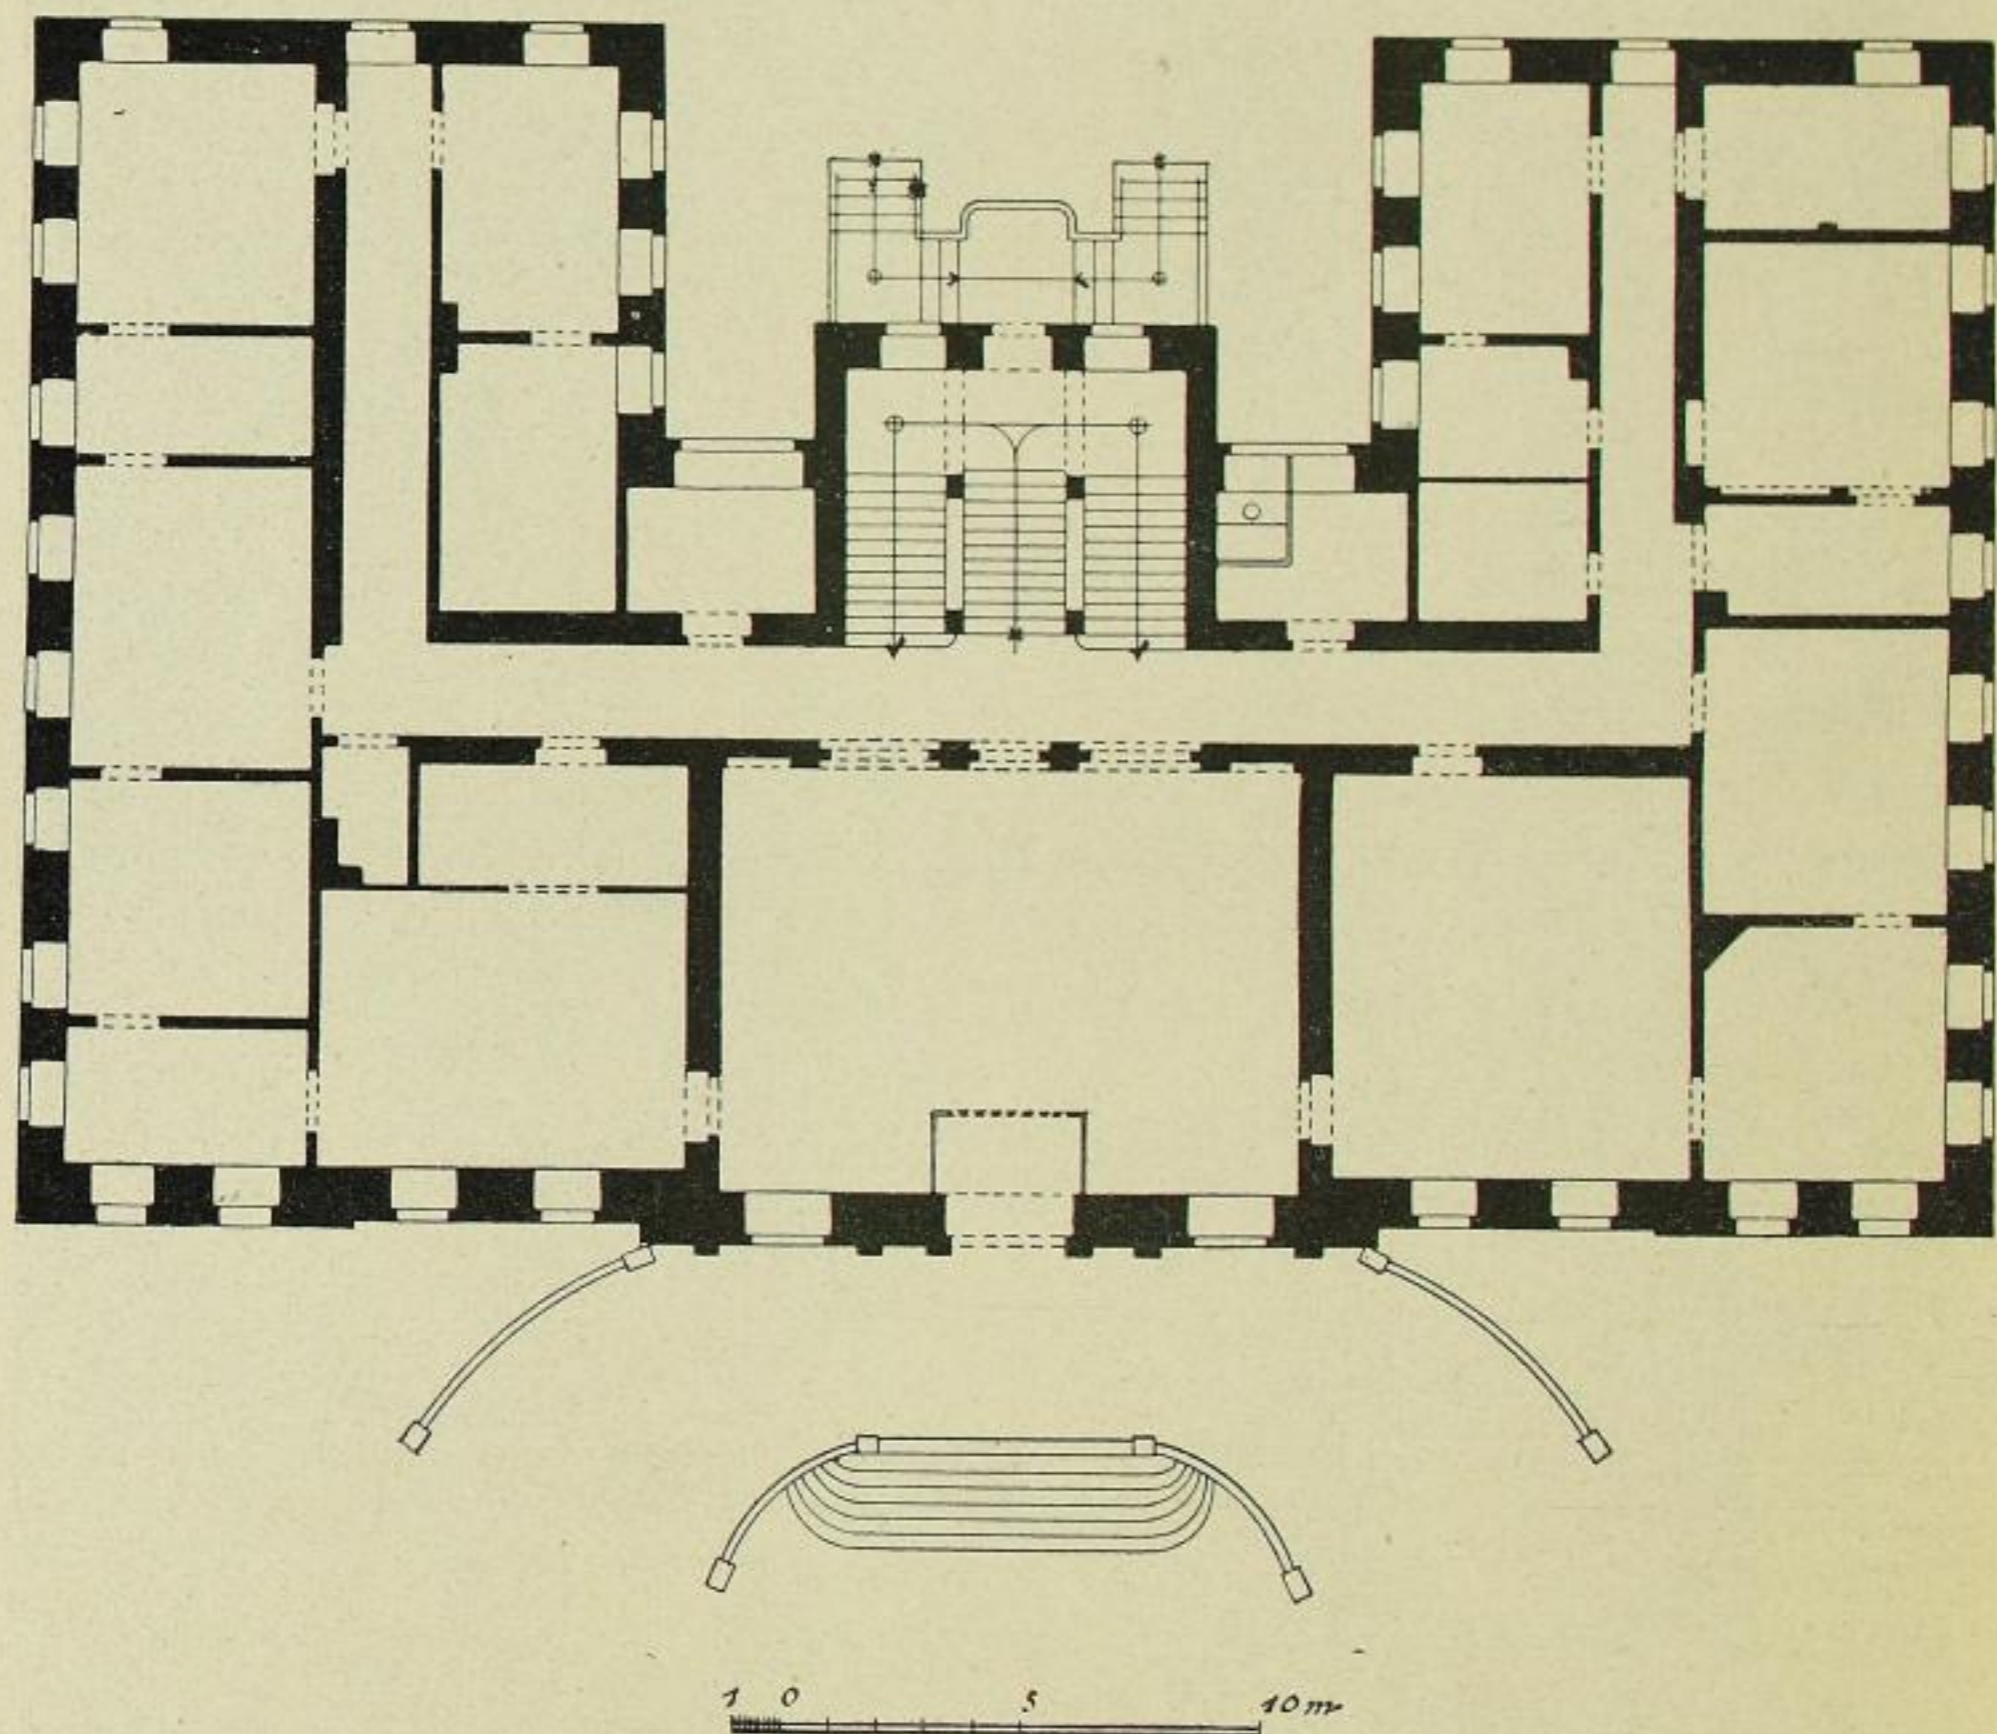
Wachau, Schloss, Grundriss des Erdgeschosses.
